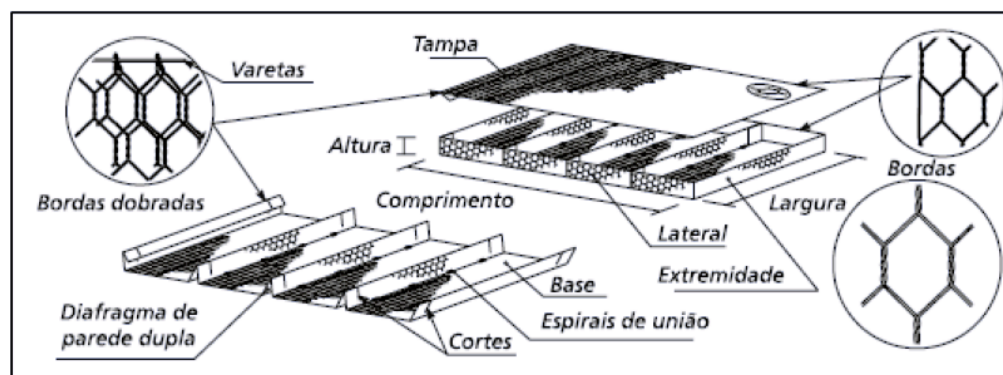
Esquema de montagem de gabião tipo colchão reno.
